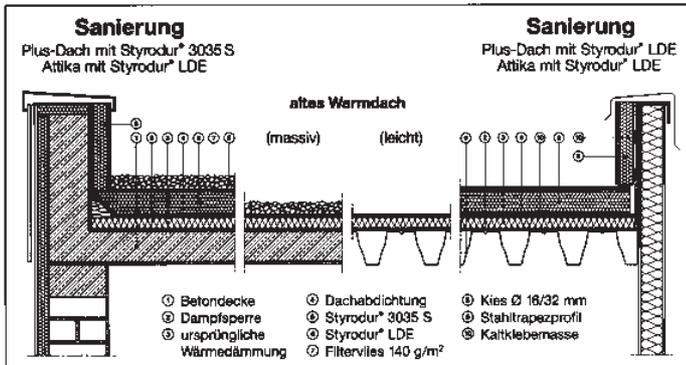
Schematische Darstellung des Plusdachaufbaus auf einer Massivdecke und auf einer Leichtdachkonstruktion
